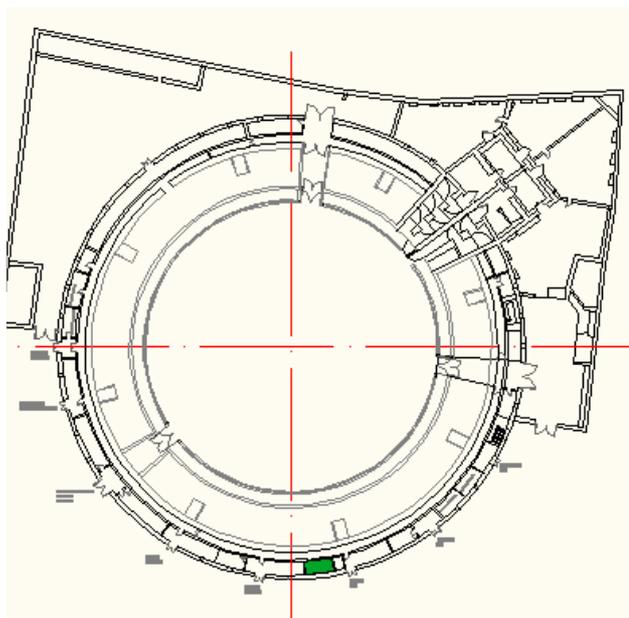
Plano de planta calle de la plaza, sala de máquina de ascensor destacada en verde.
